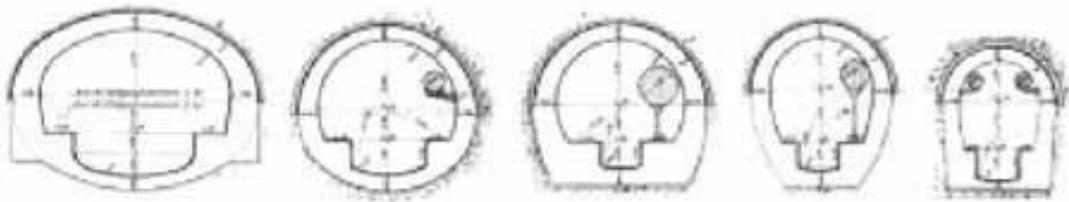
E. Belgrand, Sección de colectores y túneles de alcantarillado para la ciudad de París, 1851.
